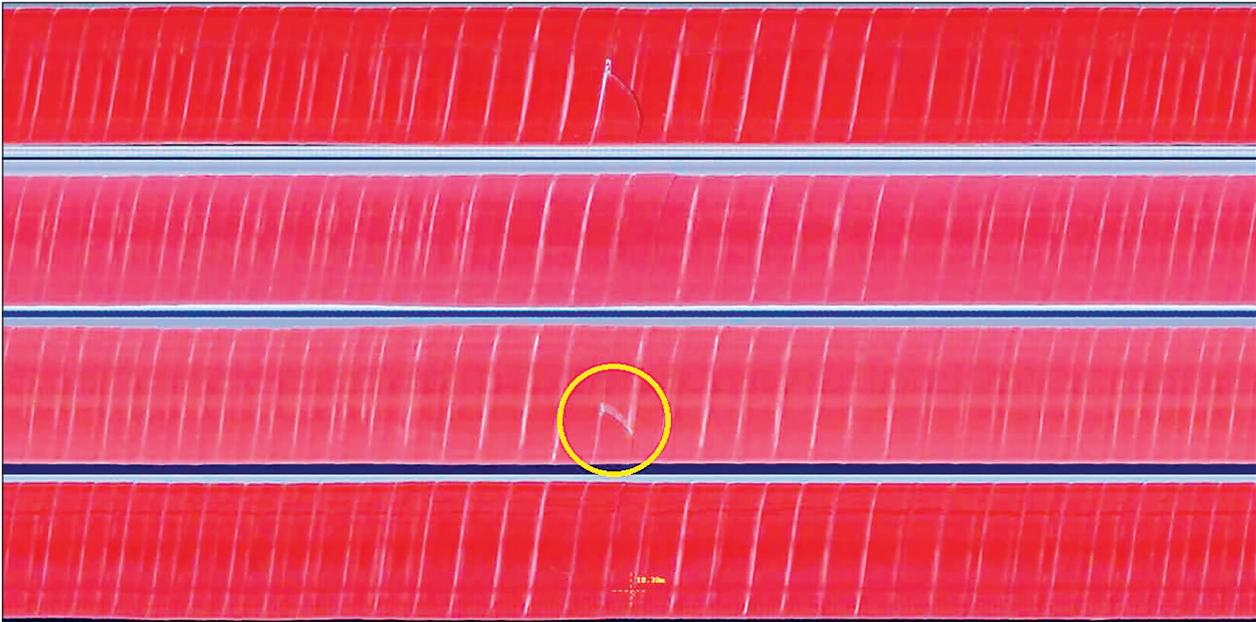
Ausschnitt Bilddokumentation nach Kamera-Befahrung: Stoß Toplage, Band zieht sich leicht zurück, unbedenklich [8]
